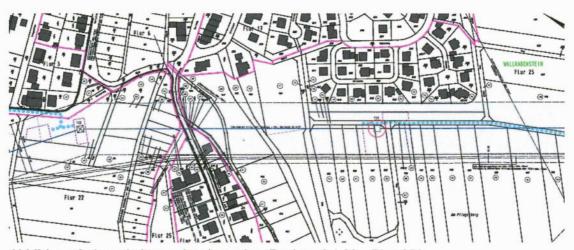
Ausschnitt aus dem Lageplan, Register 6.1.29 – Blatt 35A.
